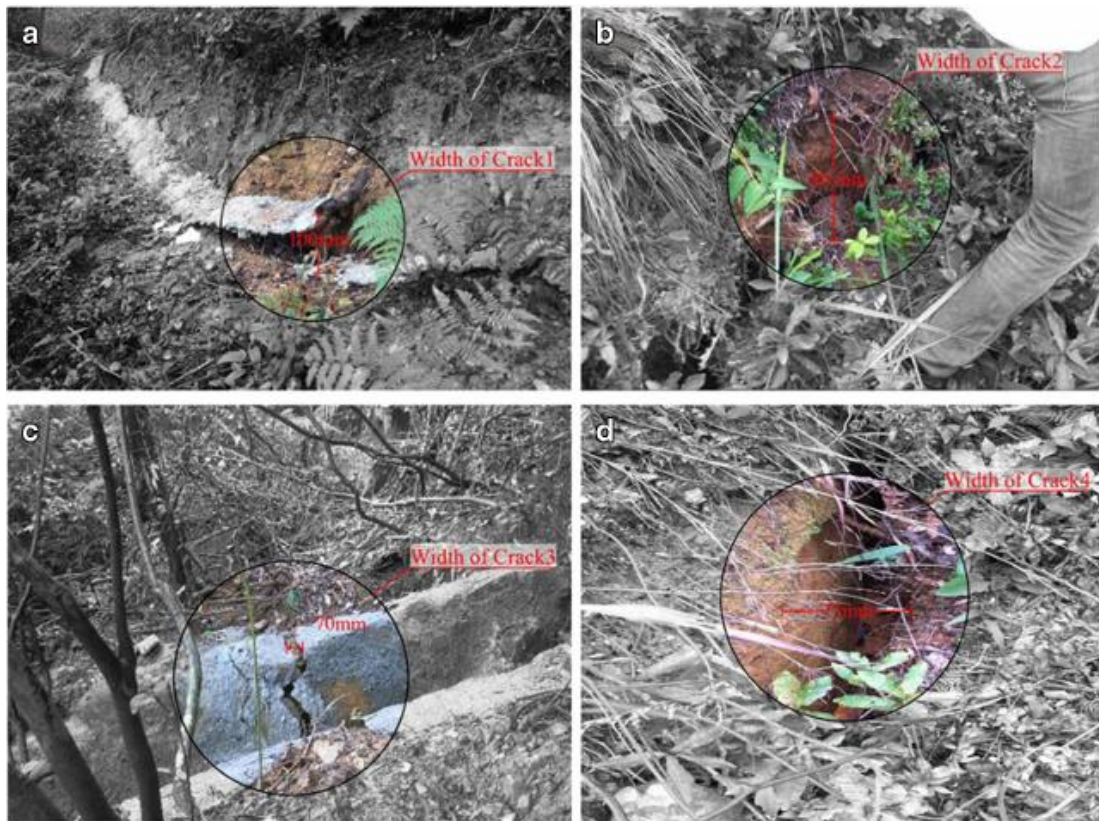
Foto de grietas; a) grieta 1, b) grieta 2, c) grieta 3, d) grieta 4
